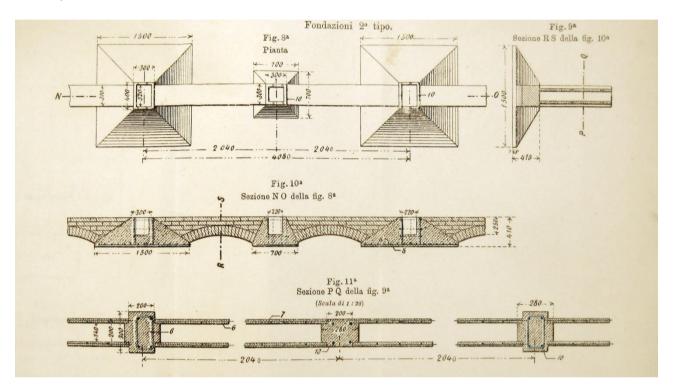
Pianta e sezione di una porzione della fondazione della seconda tranche della baracca realizzata a Santa Croce in Gerusalemme; sezioni orizzontali e verticale delle pareti perimetrali (Caveglia 1906).
